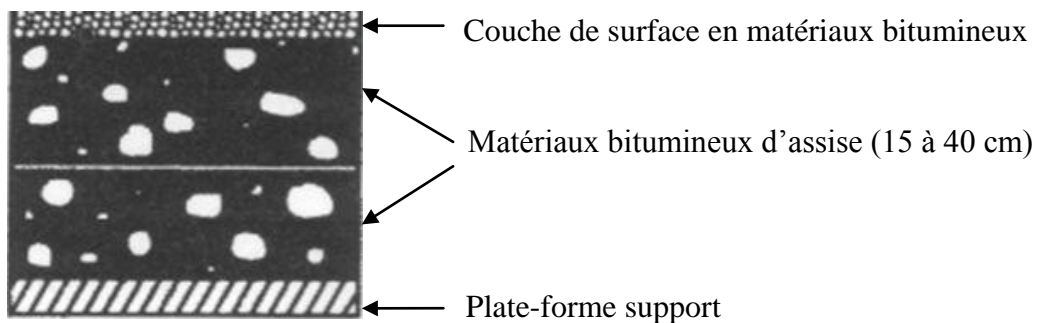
Chaussée bitumineuse épaisse [2].
